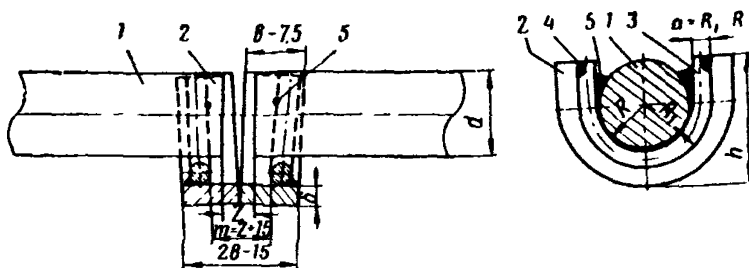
Схема сборки стыка стержней с составными частями сварной подкладки
